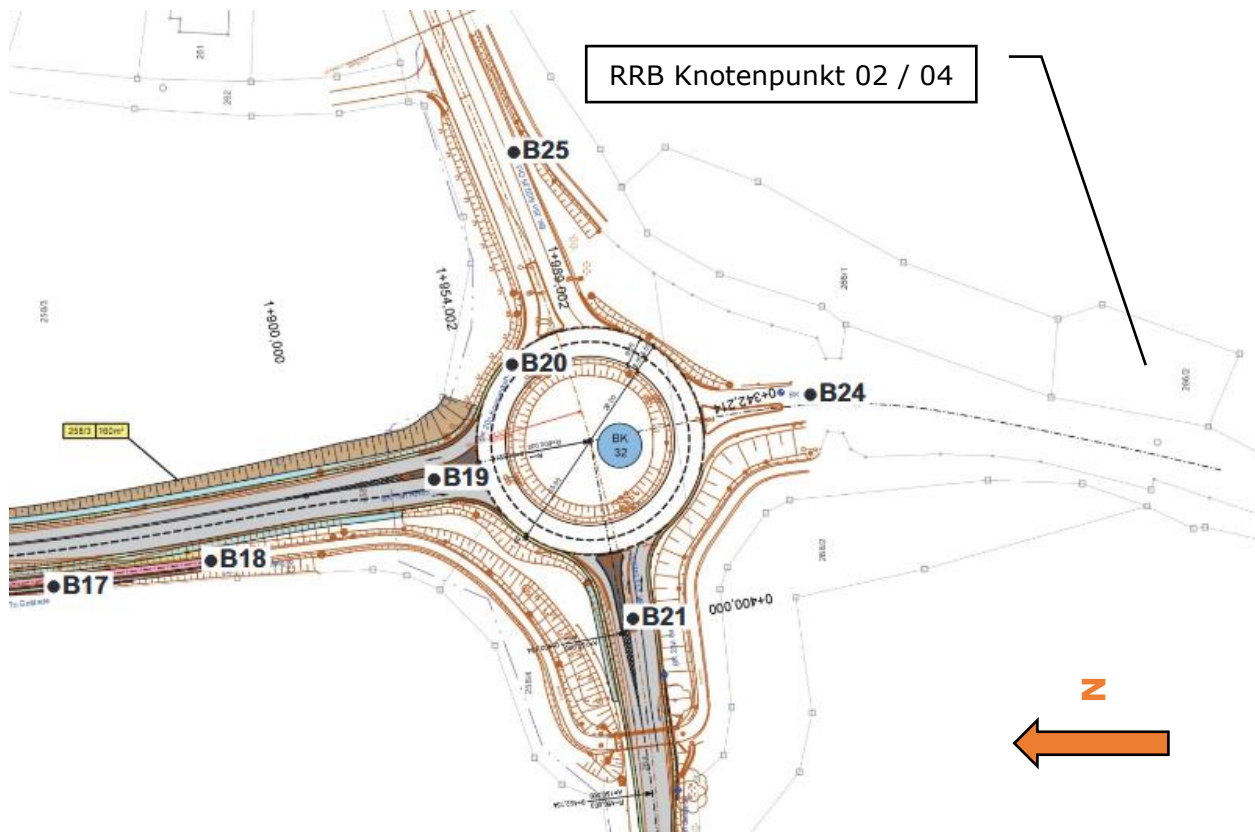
Auszug Lageplan geotechnische Untersuchungen
